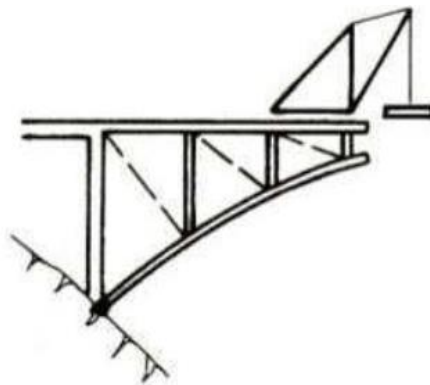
Cantiléver libre. Fuente: (Nascè y Dal Pont,1975).
